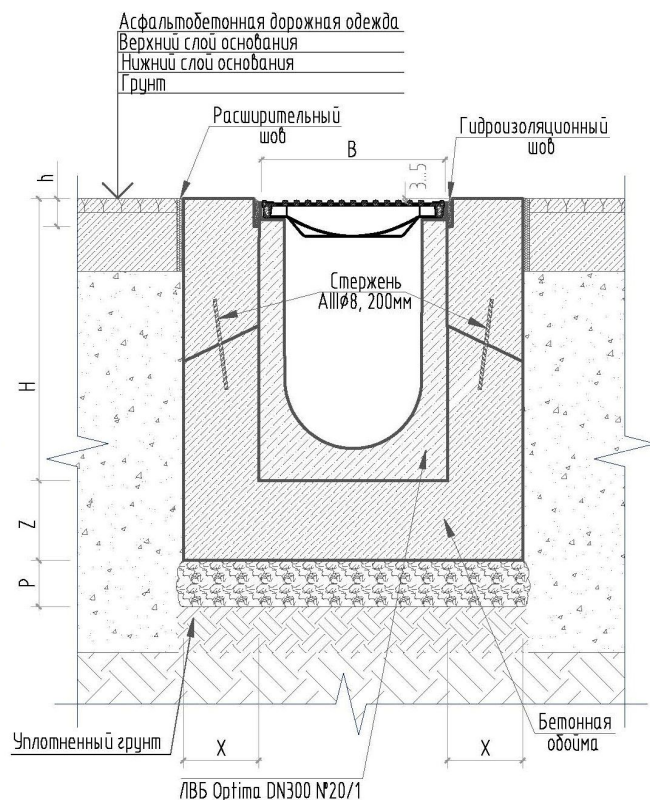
б – Устройство бетонной обоймы лотка с асфальтобетонным покрытием для классов нагрузки от D400 до E600.
